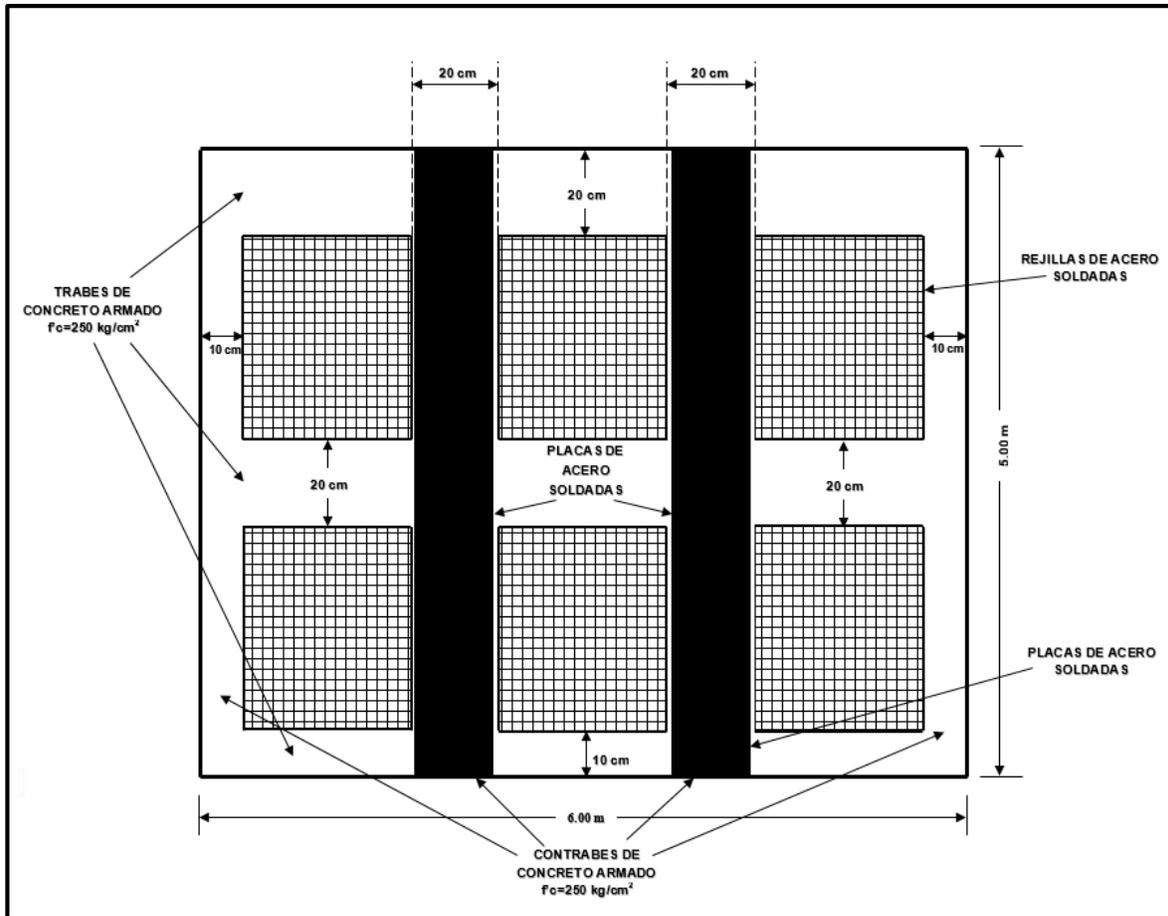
Cajón de cimentación para fosa captadora de aceite. PLANTA
